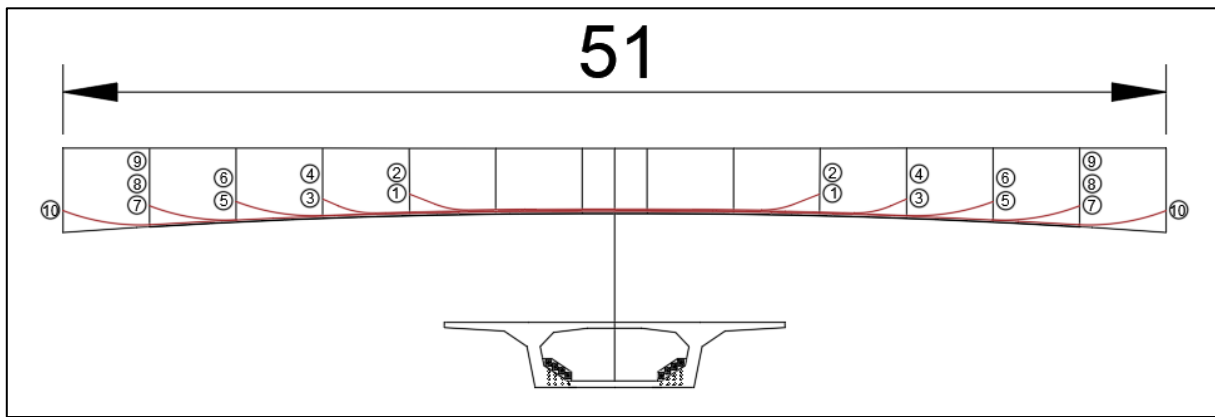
Tracé en élévation des câbles de continuité (travée centrale)
